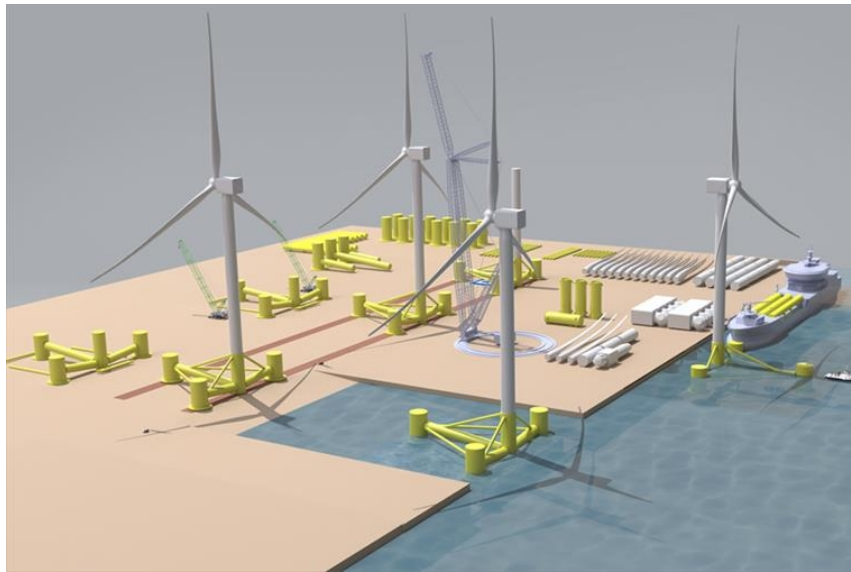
Concept de Stiesdal pour la construction de parcs éoliens flottants sur une rampe de mise à l'eau
